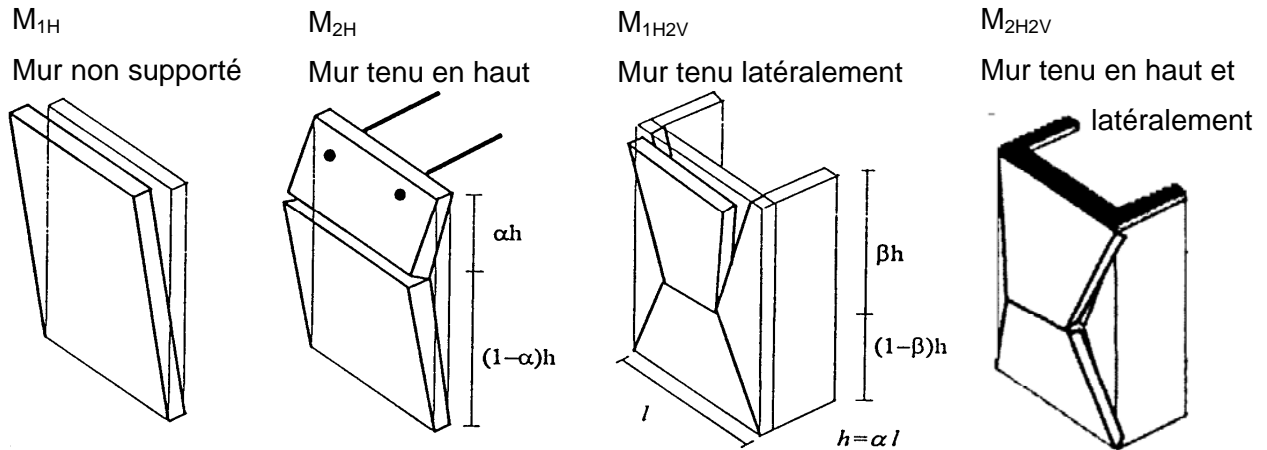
Mécanismes hors plan pour différentes conditions de liaison des murs (D'Alaya et al., 1997)
